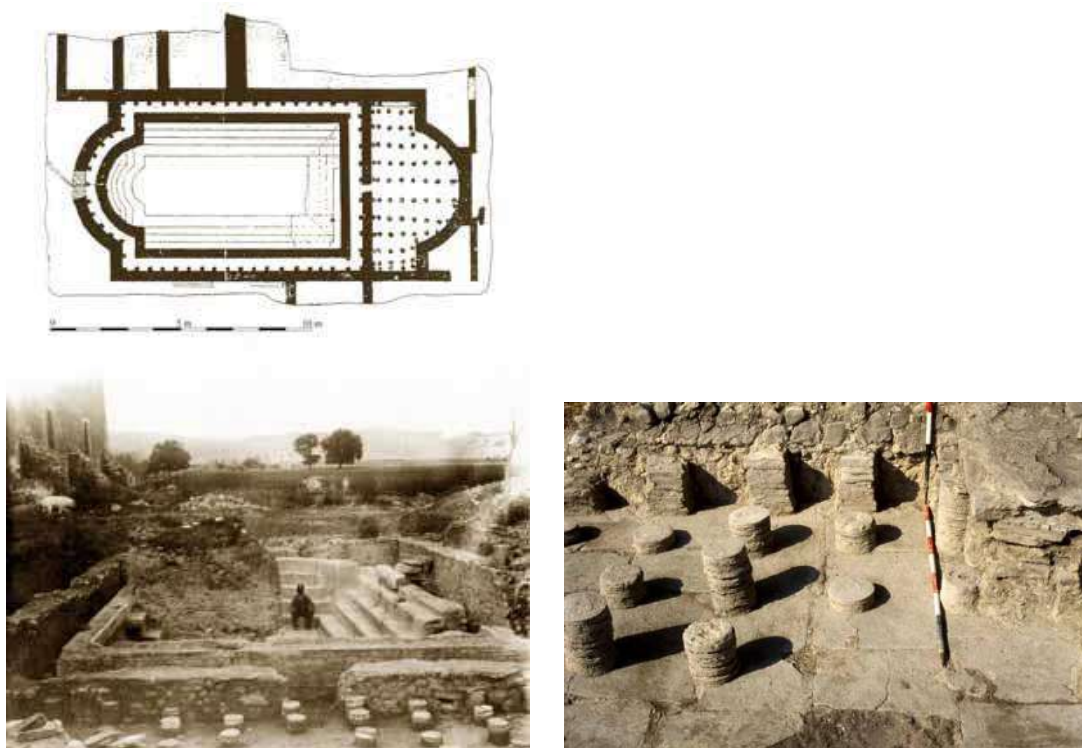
Planimetria del complesso ternale in alto, in basso una foto all'epoca dello scavo e un particolare delle *suspensurae
